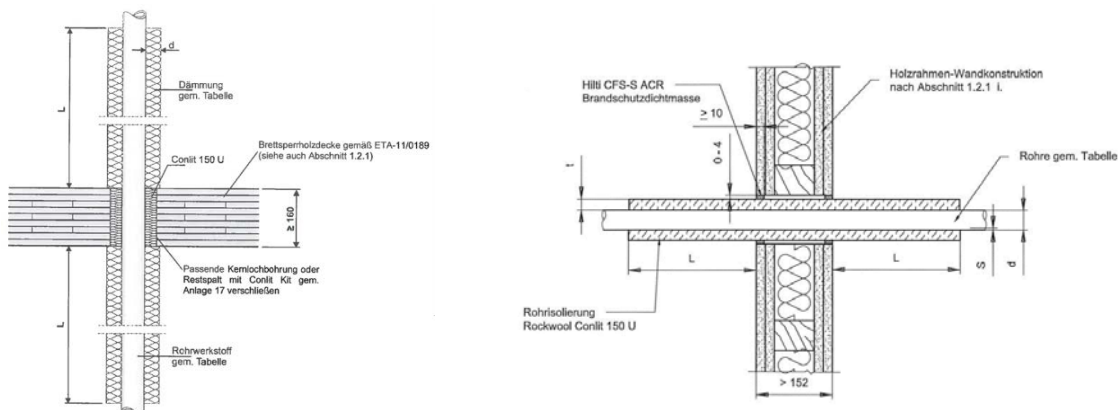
R 90 Rohrabschottung für nichtbrennbare Rohrleitungen in Brettsperrholzdecke (links) [194] und in Holzrahmenwand (rechts) [196]
